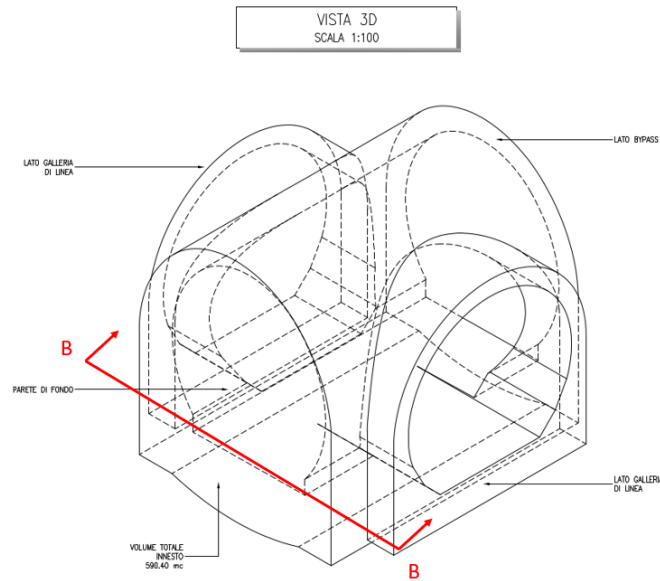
Vista 3D della sezione innesto (IBOU1BEZZWBGNO400009)
